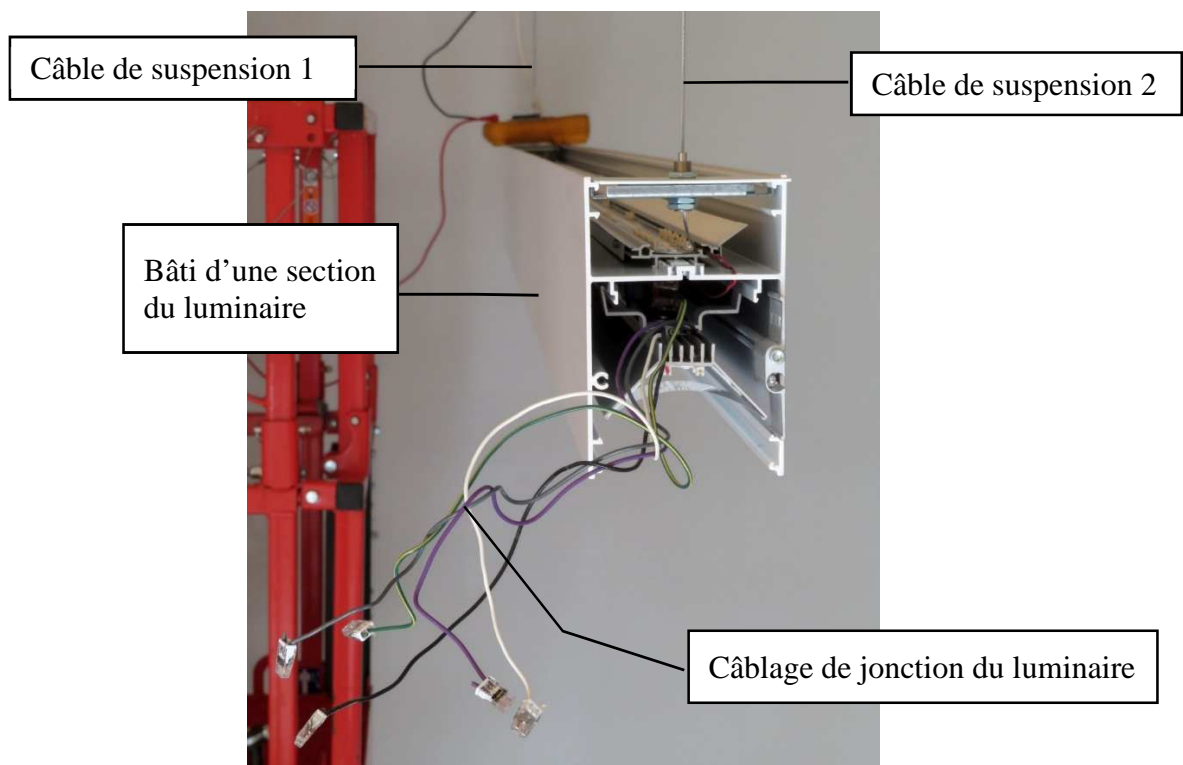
Bâti du luminaire relié au câble de suspension et câblage de jonction du luminaire
